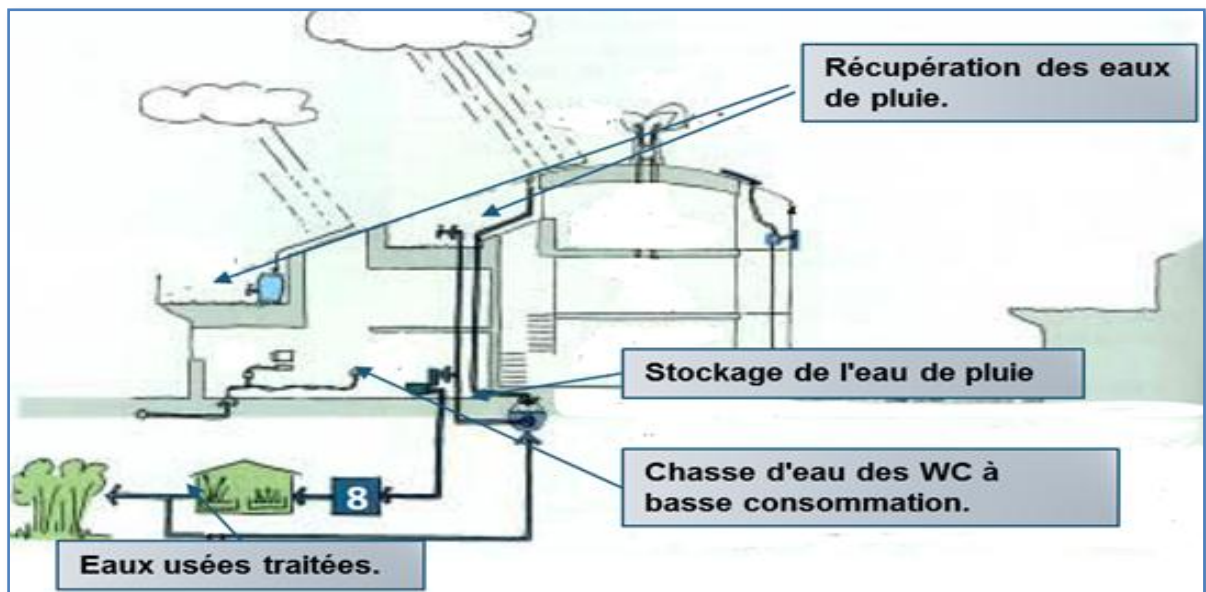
Coupe schématique sur l'éco gestion de l'eau.
